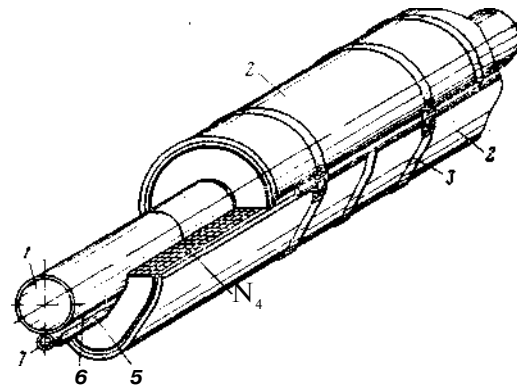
Теплоизоляция нефтепродуктопровода со спутником:
